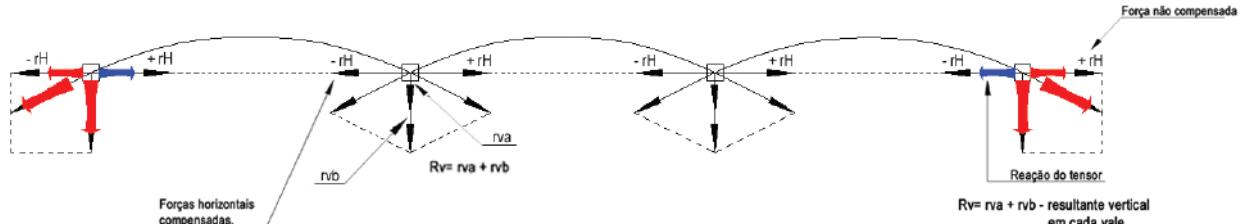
Esquema das descargas e dos empuxos horizontais. (*-5).
